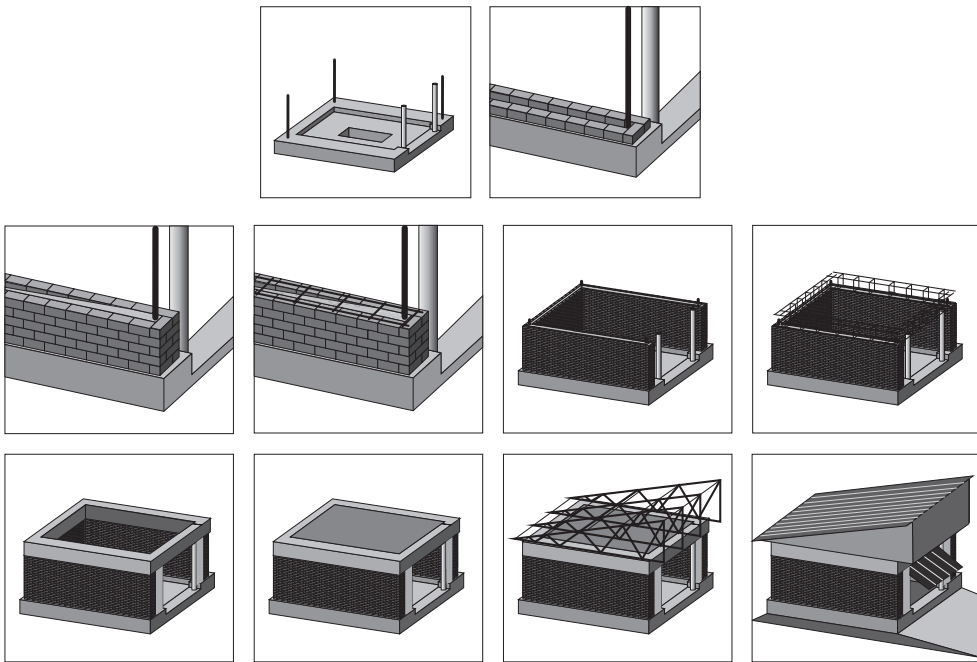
Строительство гаража в кирпич под плиты перекрытия
